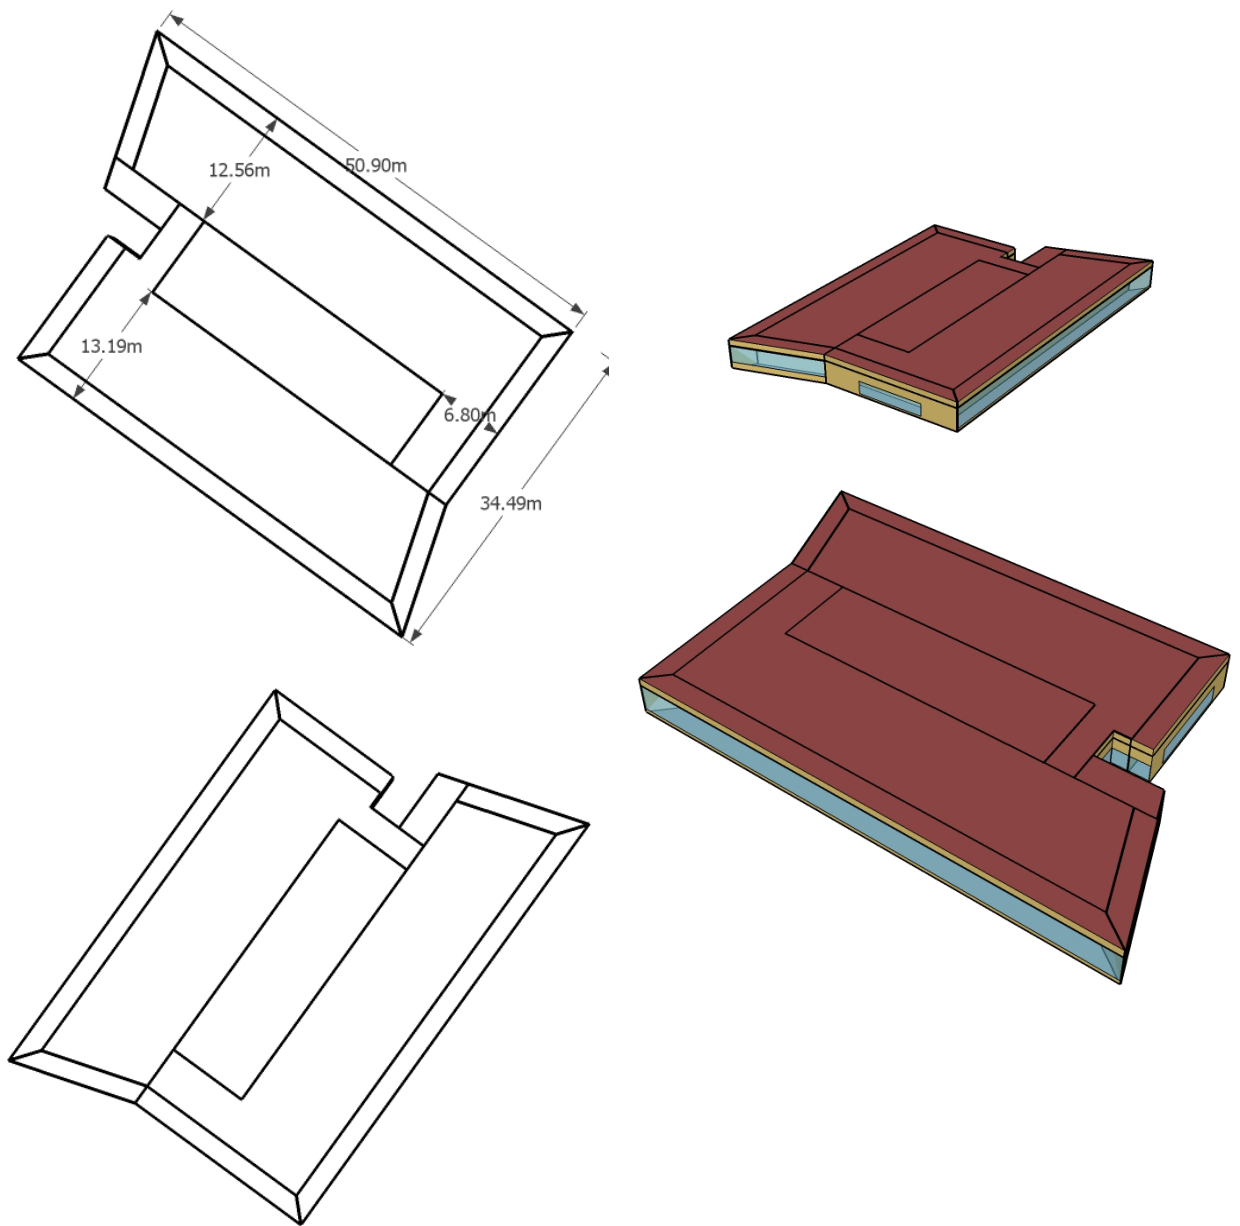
Planta e modelo espacial de pavimentos tipo do Proposed Building para o estudo de caso #7
